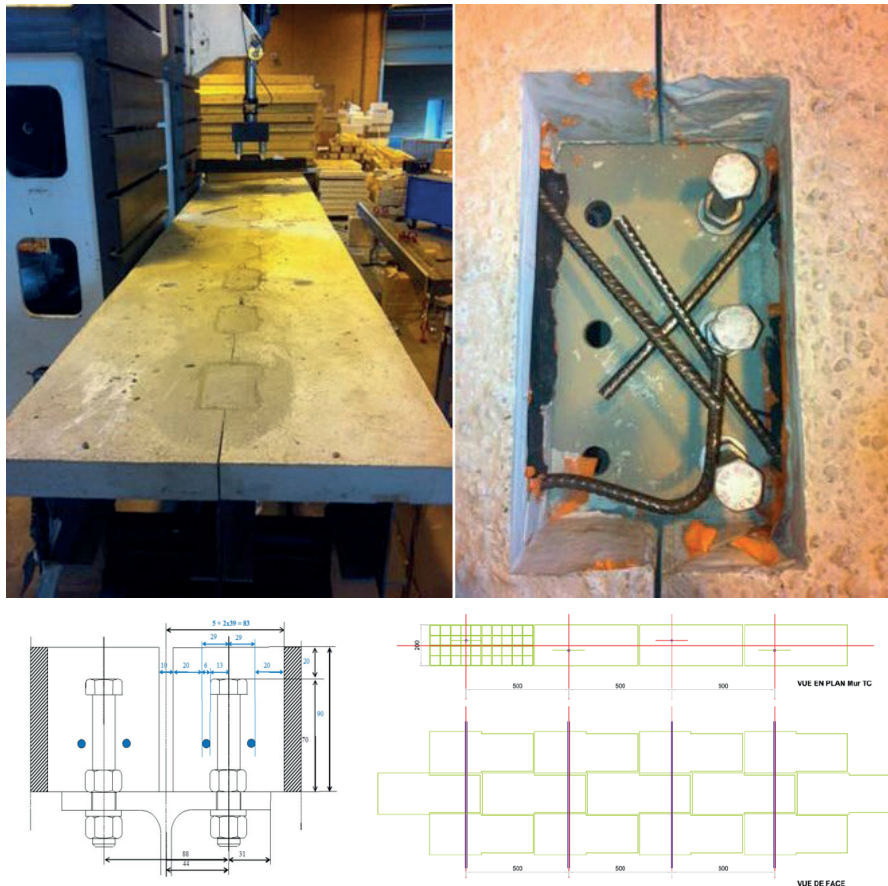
Systèmes constructifs du projet Demodolor (Plancher mixte acier-béton et maçonnerie porteuse à sec)
